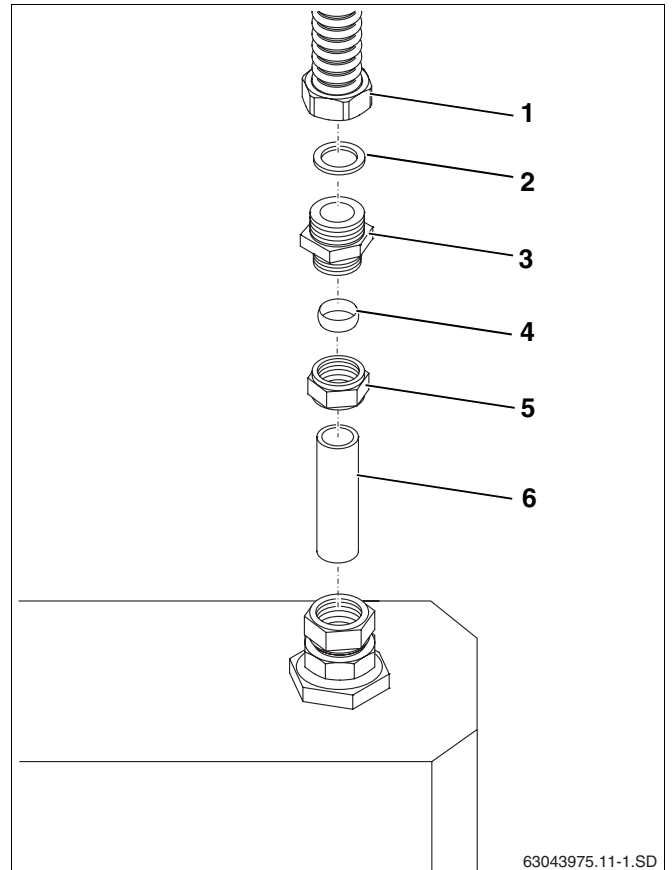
Twin Tube DN 20 bei Klemmringverschraubung 22 mm
